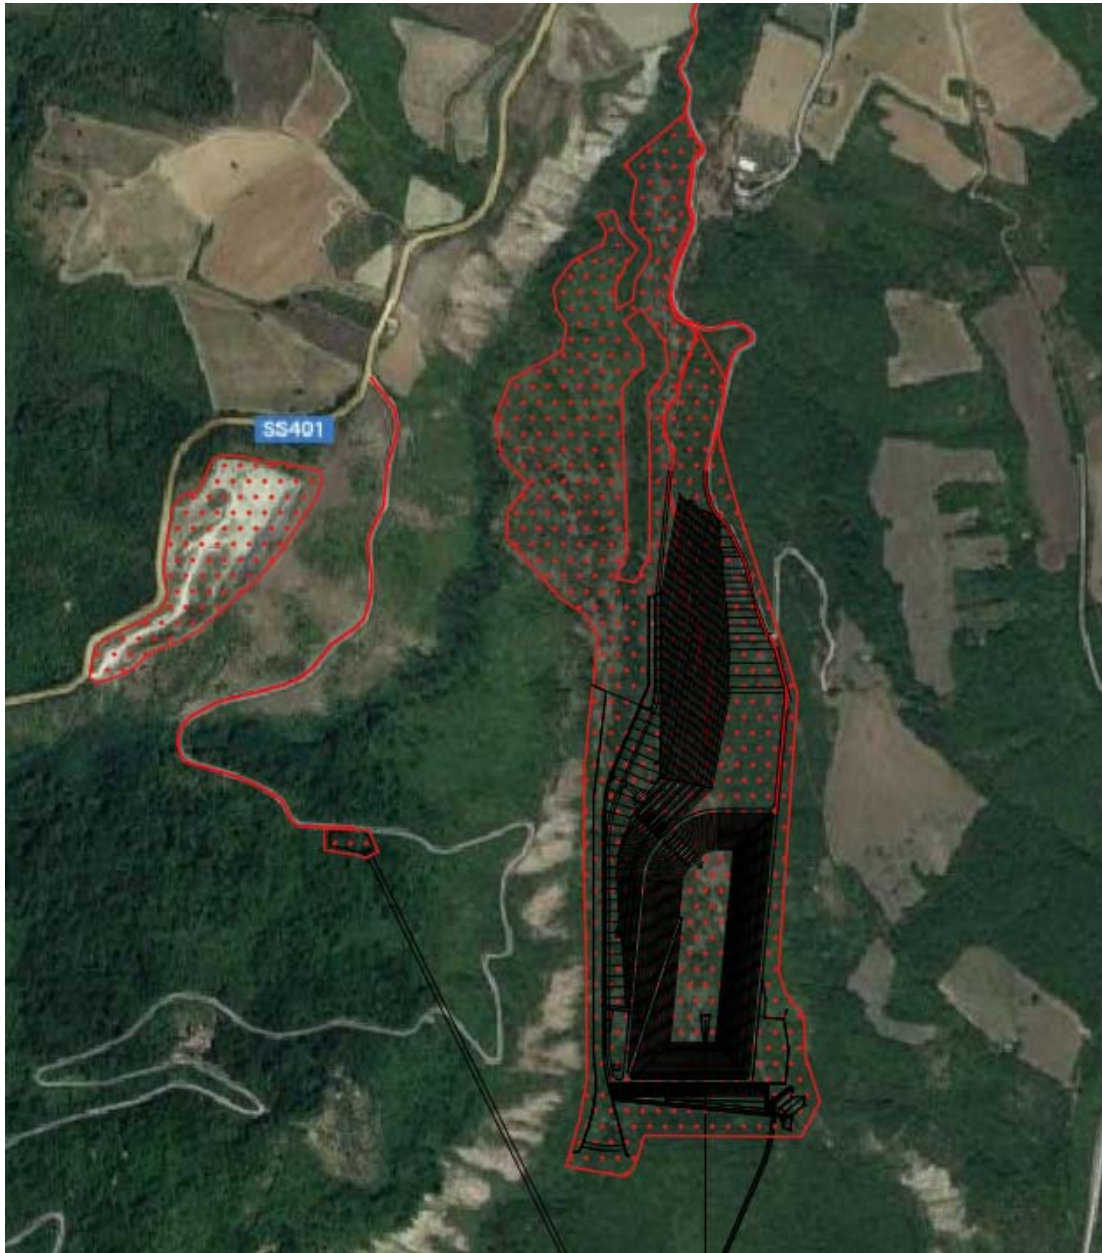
Cantiere bacino di valle "Pescopagano", zona Sud (area a destra)
